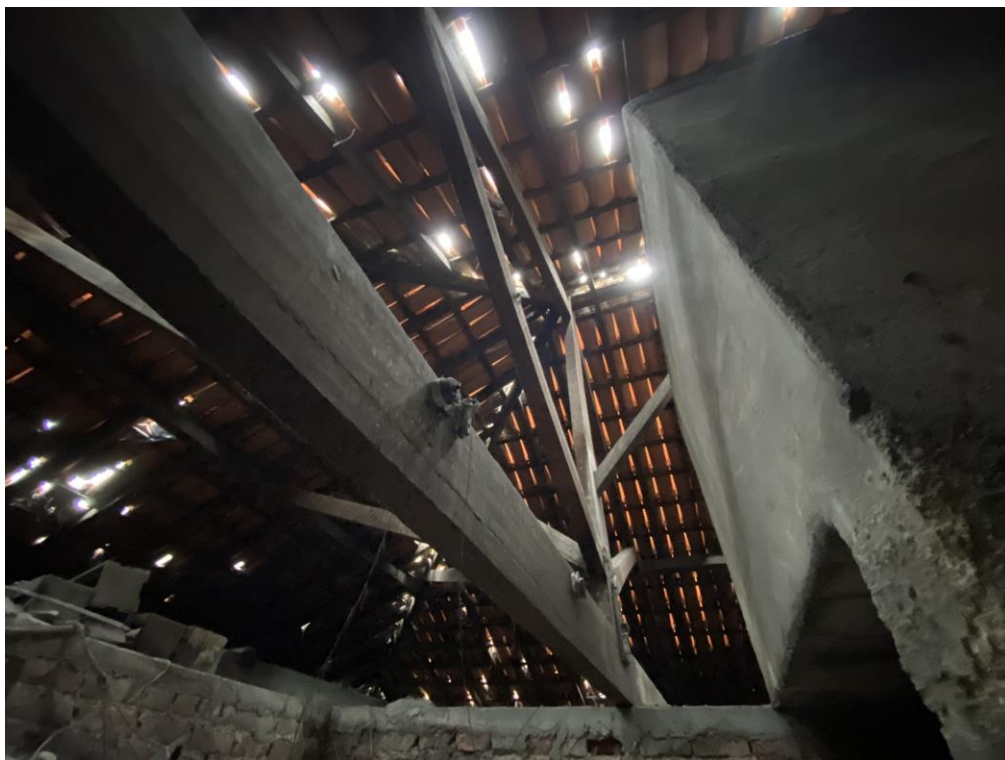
Outra vista, vendo-se uma caixa d'água em concreto.
